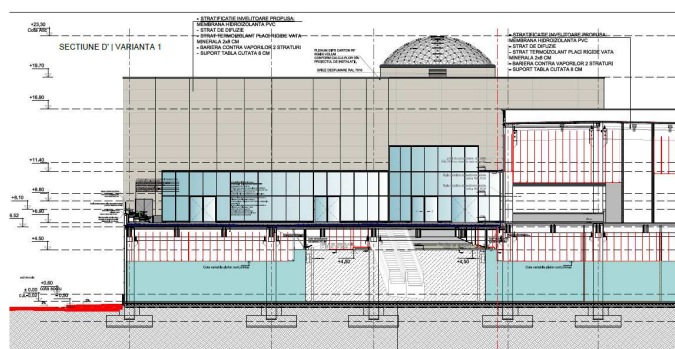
Fațadă laterală (Planșe Birou arhitectură HBRO)
